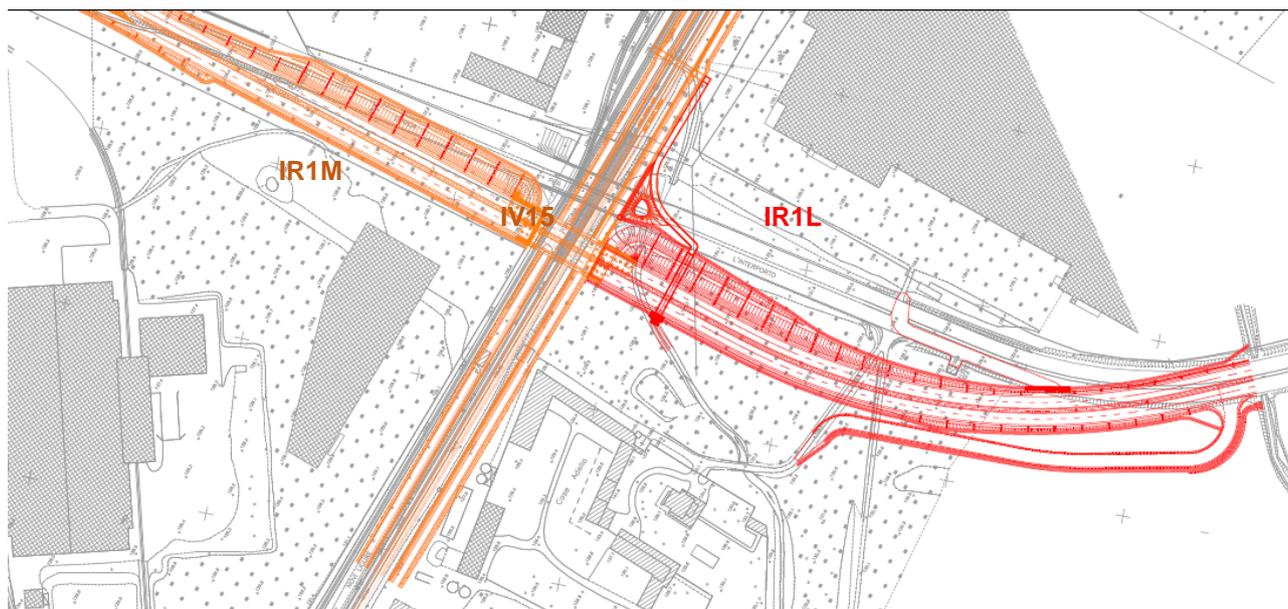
Localizzazione della rampa di approccio IR1L nel progetto in variante (in colore rosso)
